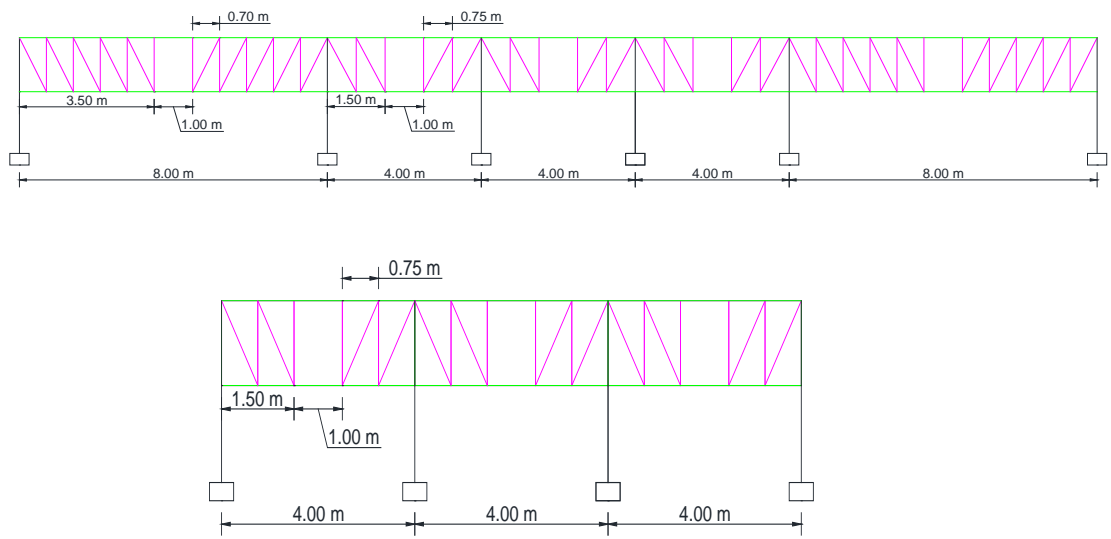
Configuración de los pórticos con viga reticulada y el segmento especial Vierendeel en la dirección X.
